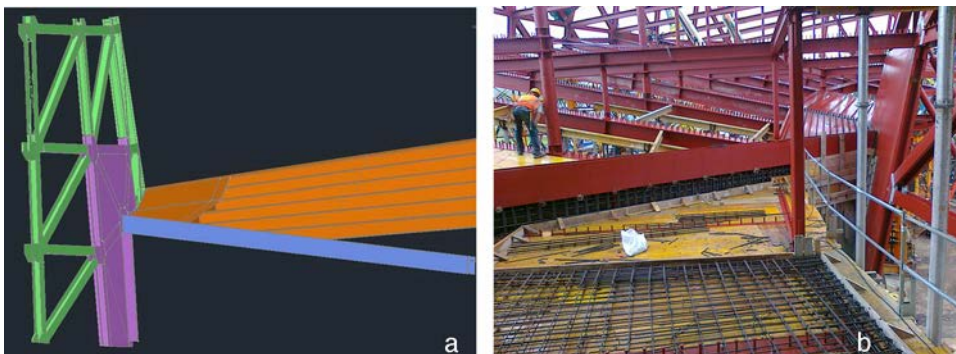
Refuerzo de chapa en el forjado de fondo. Imagen de la modelización 3D (a) y fotografía de la ejecución (b).
